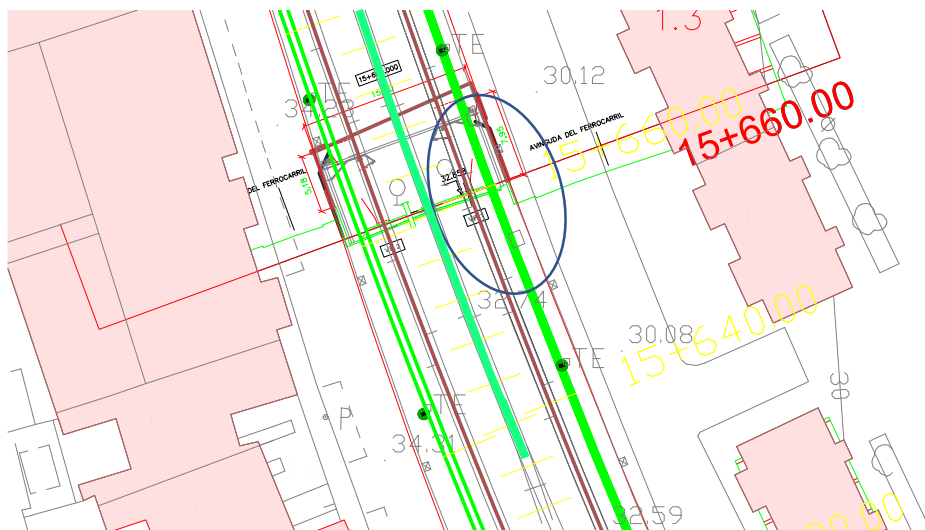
Plano ejemplo de ubicación de la minibarrera
